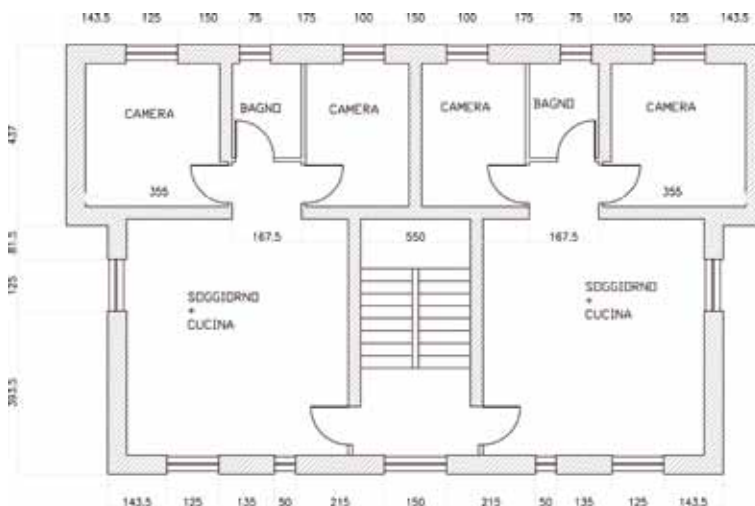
Pianta piano tipo dell'edificio da calcolare
